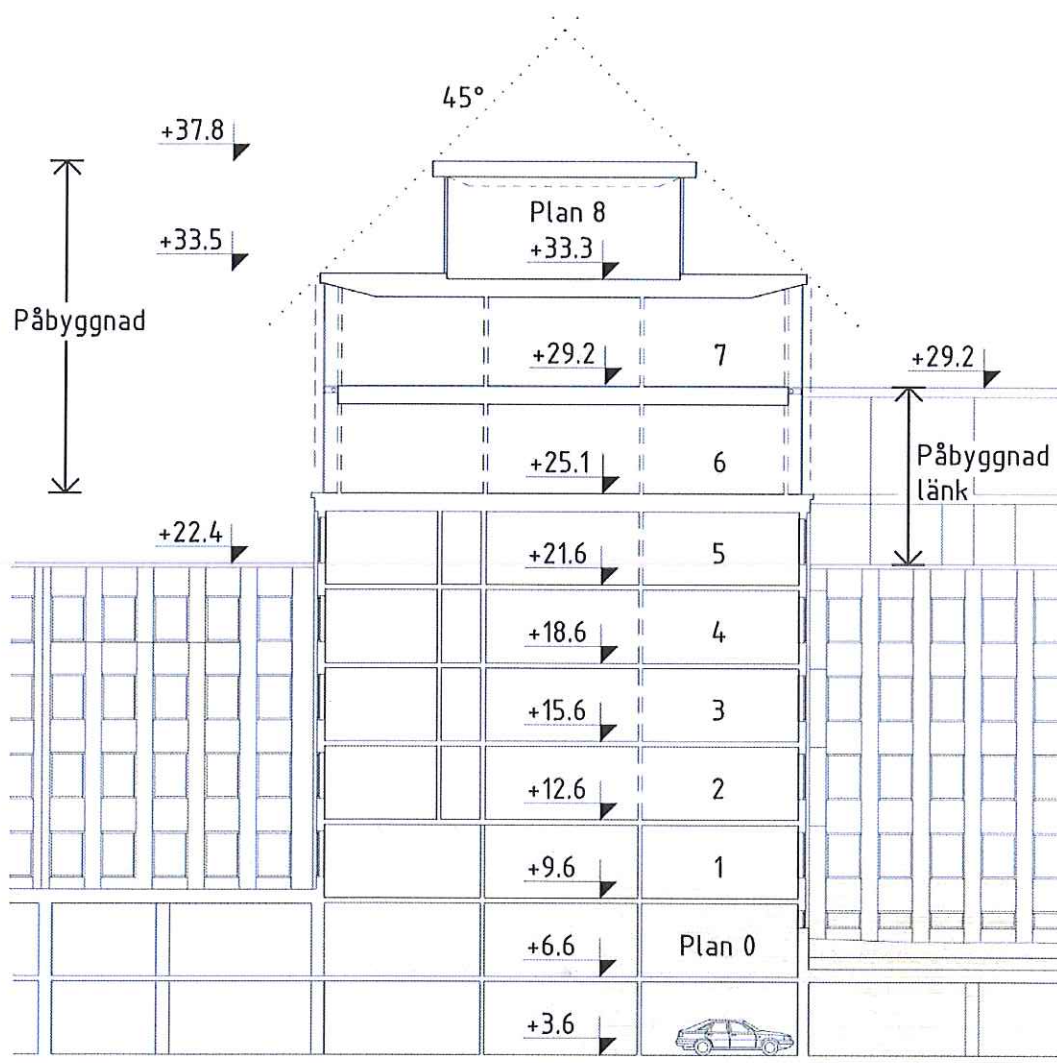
Principer påbyggnad. Den översta tredje våningen är betydligt mindre än de övriga två. Den visade påbyggnadens yta är sammanlagt ca 6200 kvm BTA, varav 2790 kvm BTA/plan 6, 2470 kvm BTA/plan 7 och 950 kvm på den översta våningen (plan 8).
